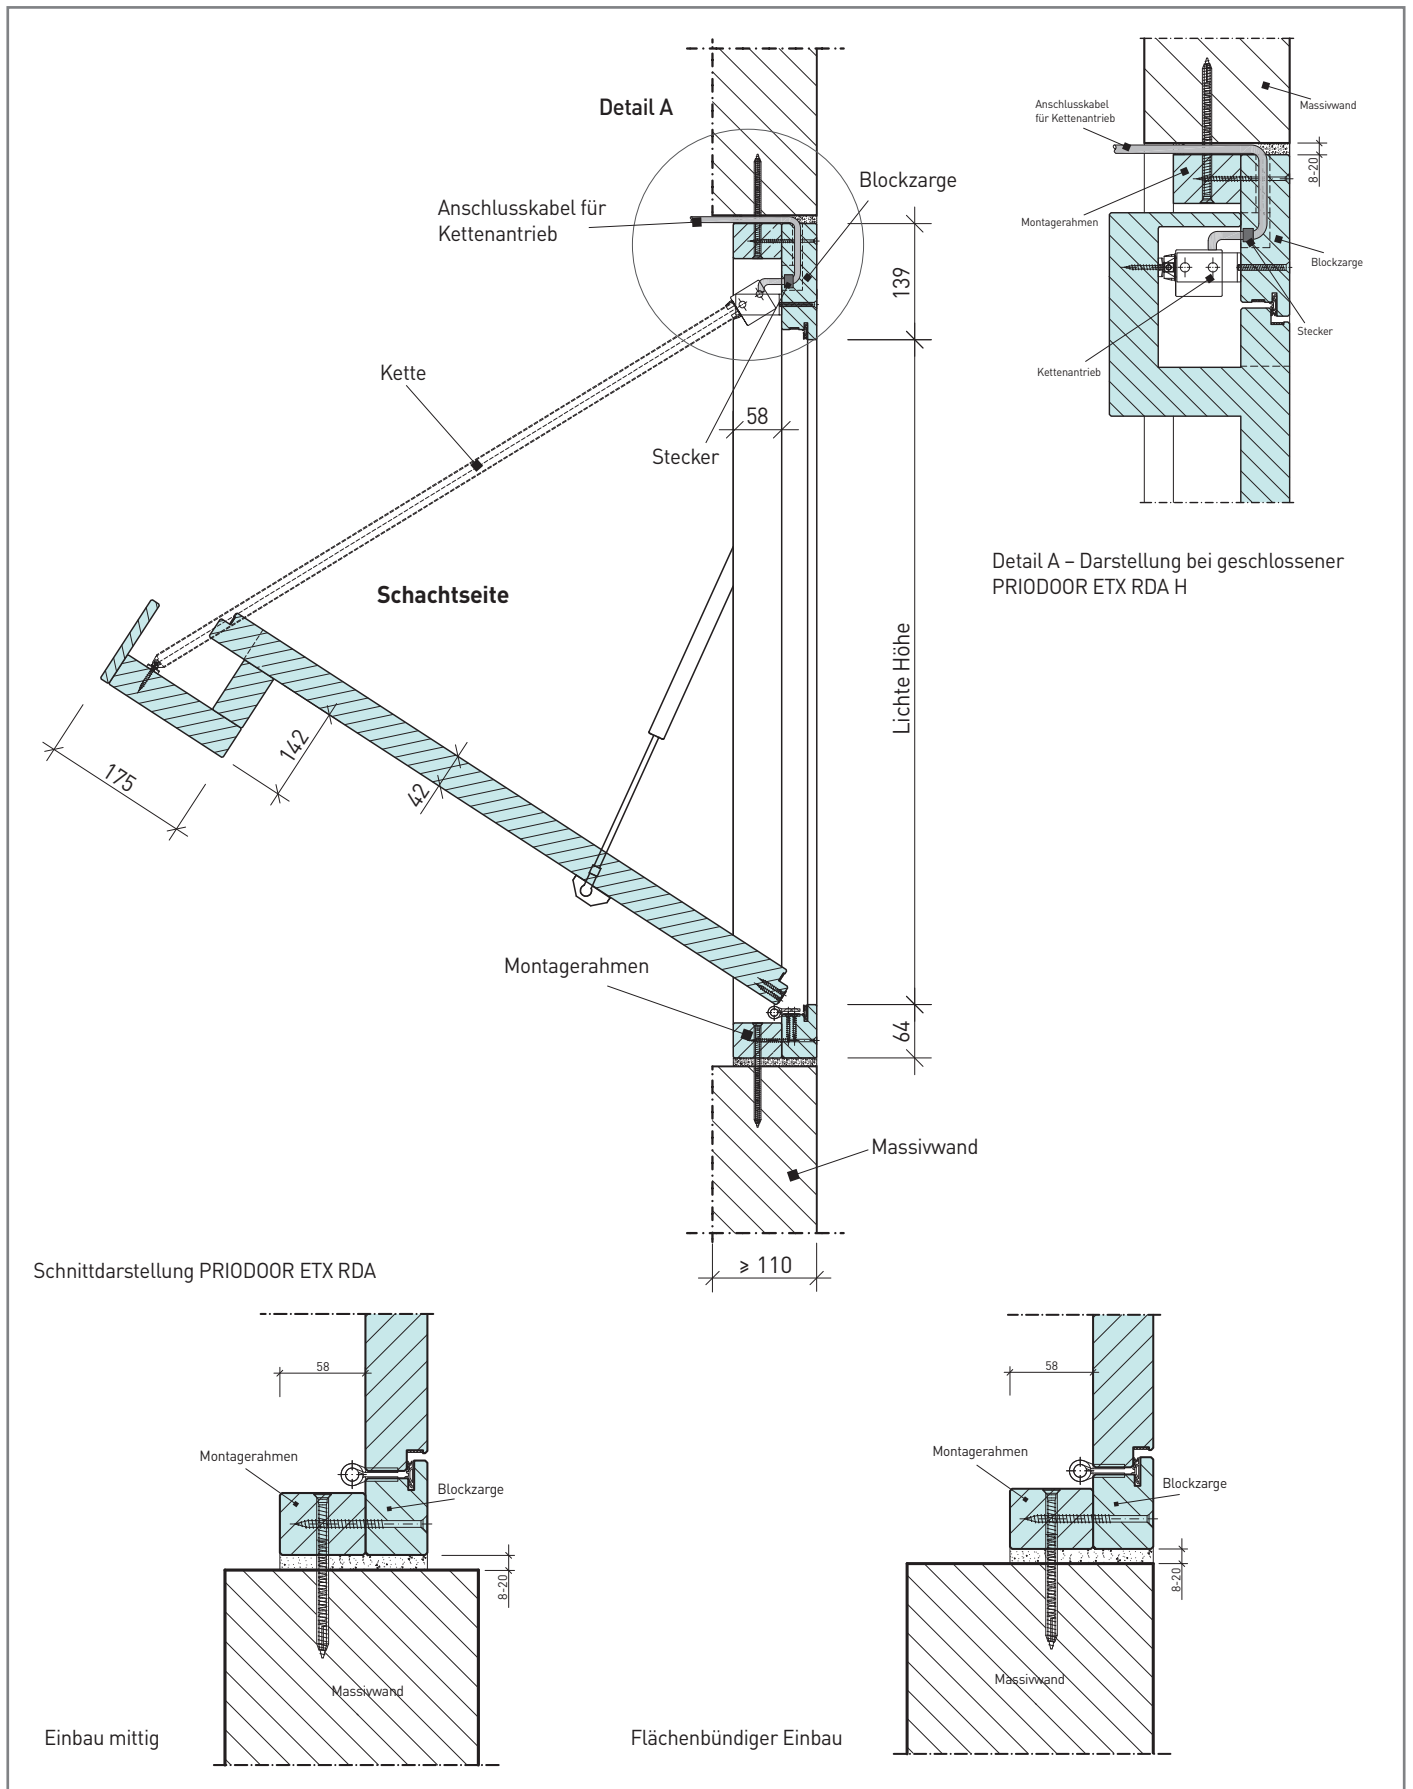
Detail A – Darstellung bei geschlossener PRIODOOR ETX RDA H
